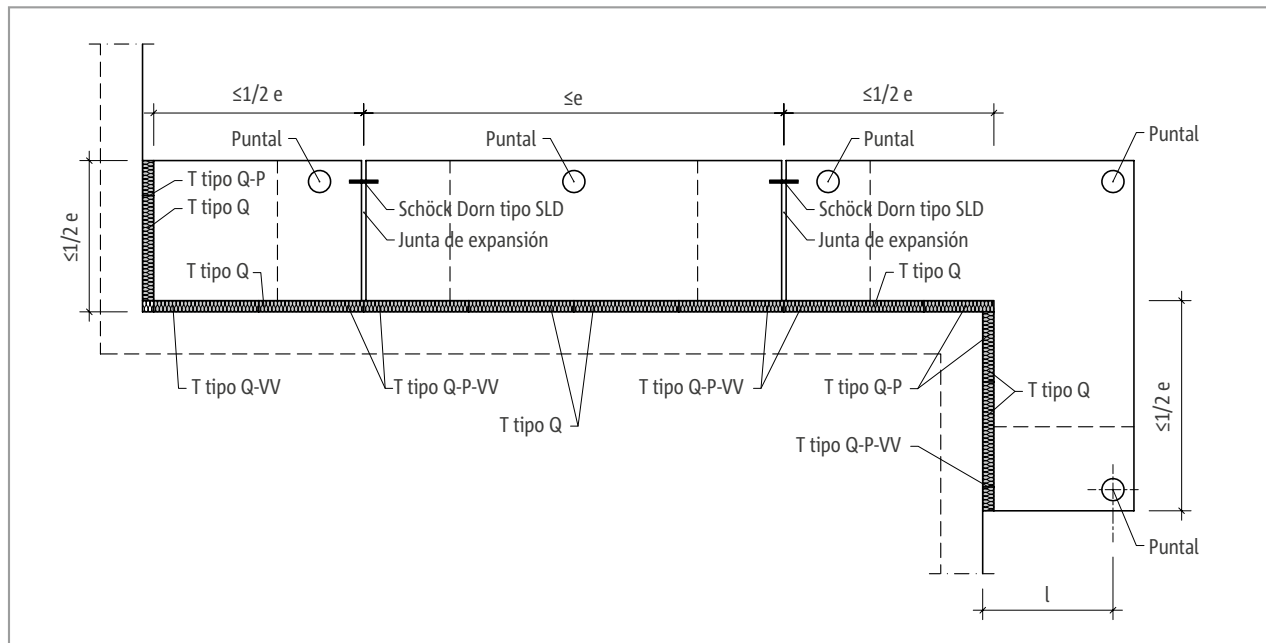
Schöck Isokorb® T tipo Q-P, Q-P-VV: Disposición de las juntas de expansión
